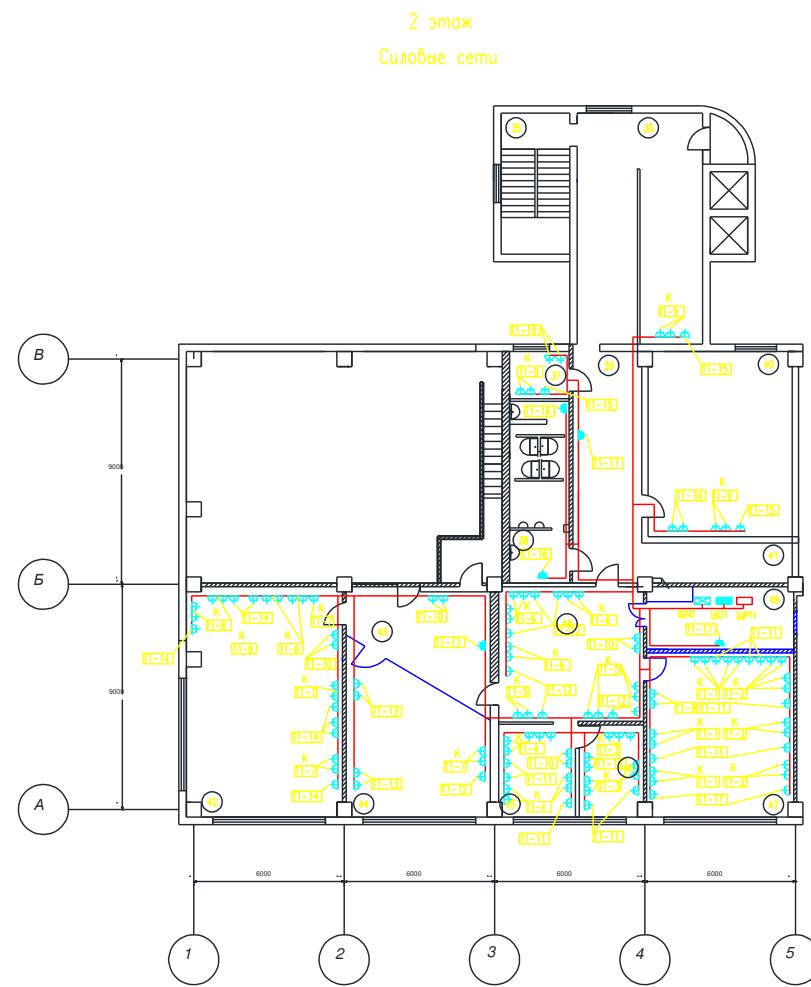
План силовых сетей 2-го этажа административного здания
